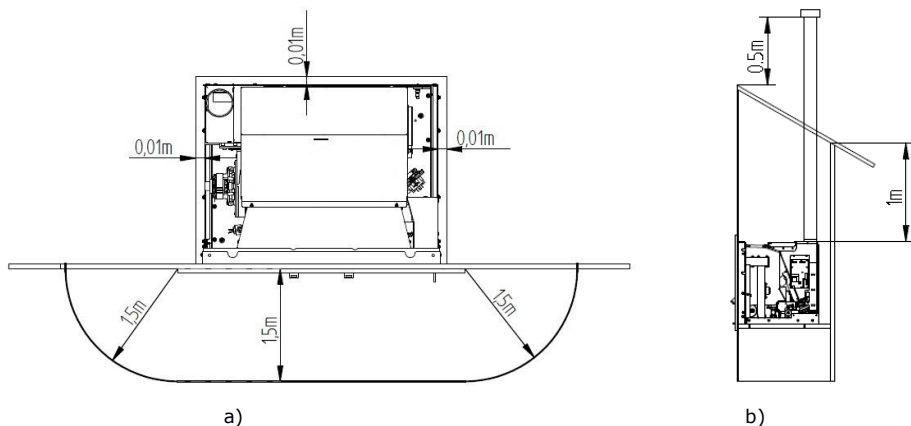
distanze minime a tutte le superfici: a) vista dall'alto della installazione di apparecchiature; b) vista laterale dell'apparecchiatura di installazione.
